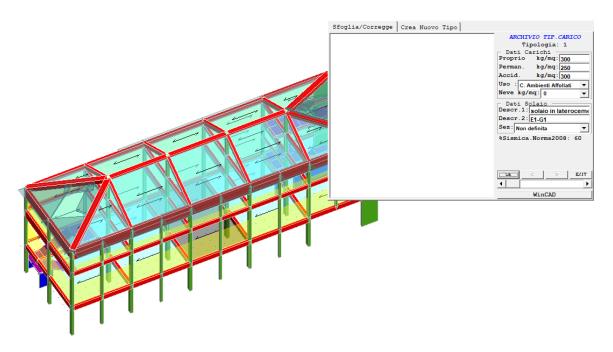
Assegnazione dei carichi dei solai dall'input impalcati
